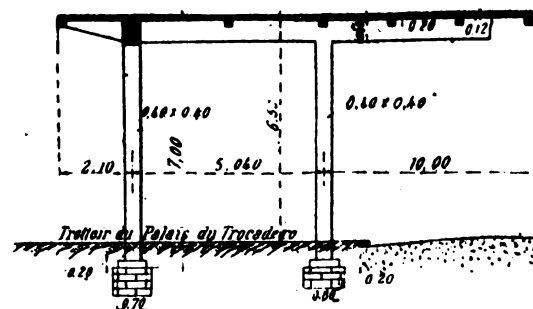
Coupe verticale longitudinale de la passerelle.
